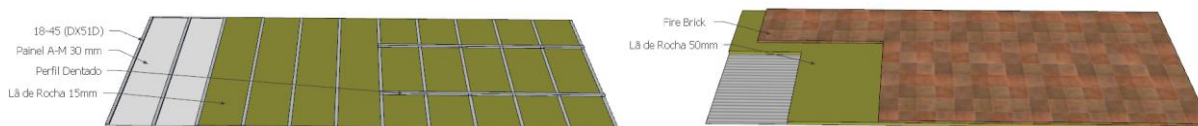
Soluções construtivas adotadas para o pavimento e para o teto, respetivamente.
